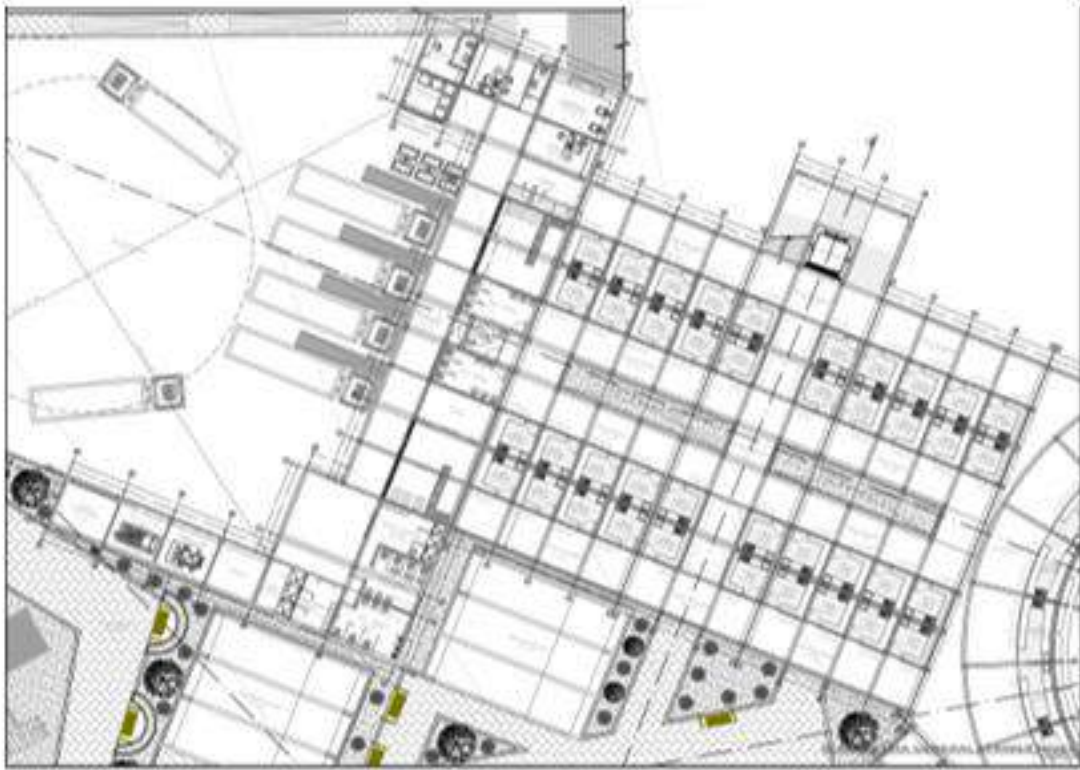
Plano arquitectónico de bloque A y B Primer piso
